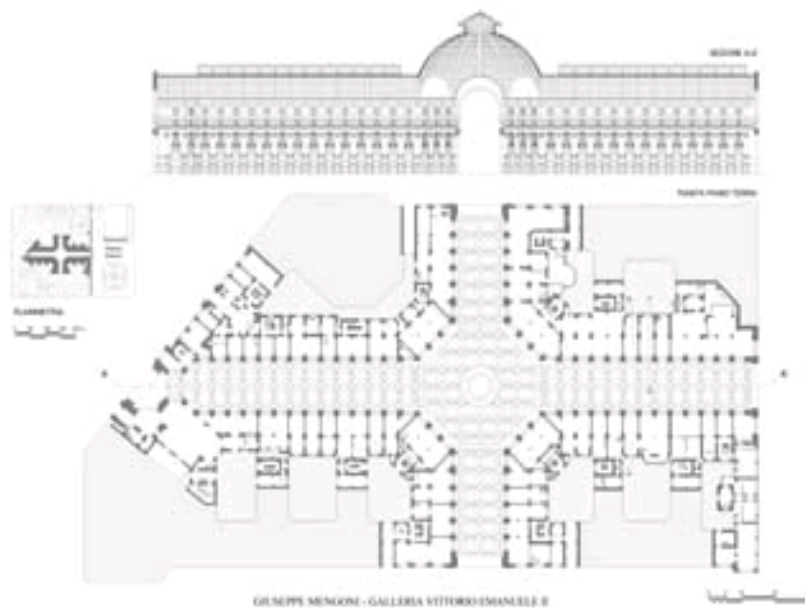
Reproducción del plano en planta y sección longitudinal de la galería Vittorio Emanuele de Milán.
